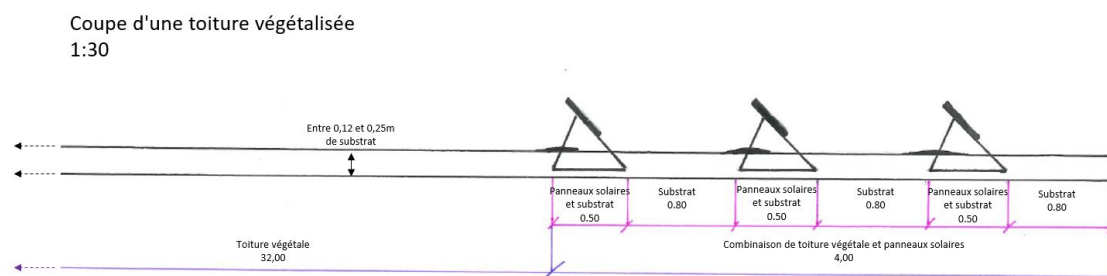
Schéma de principe d'une toiture végétalisée et d'une toiture mixte végétation et panneaux solaires.
